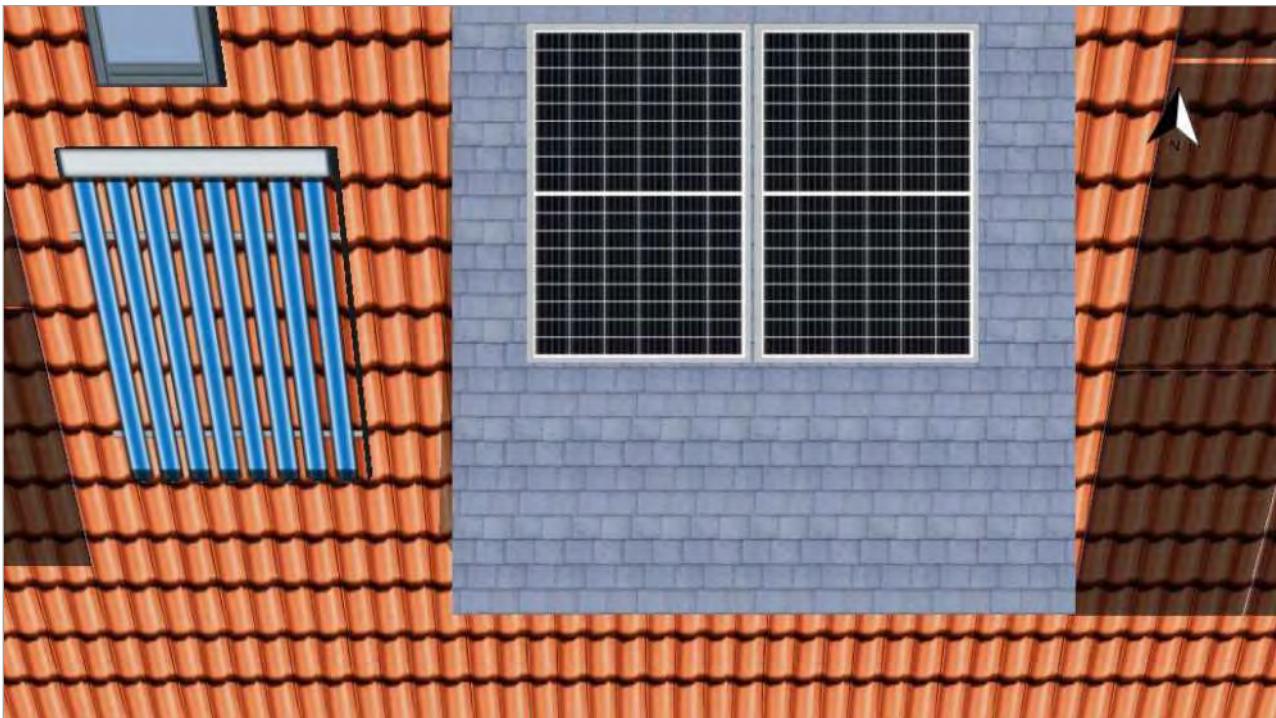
Modulfläche - Dachgaube 01-Dachfläche Süd
